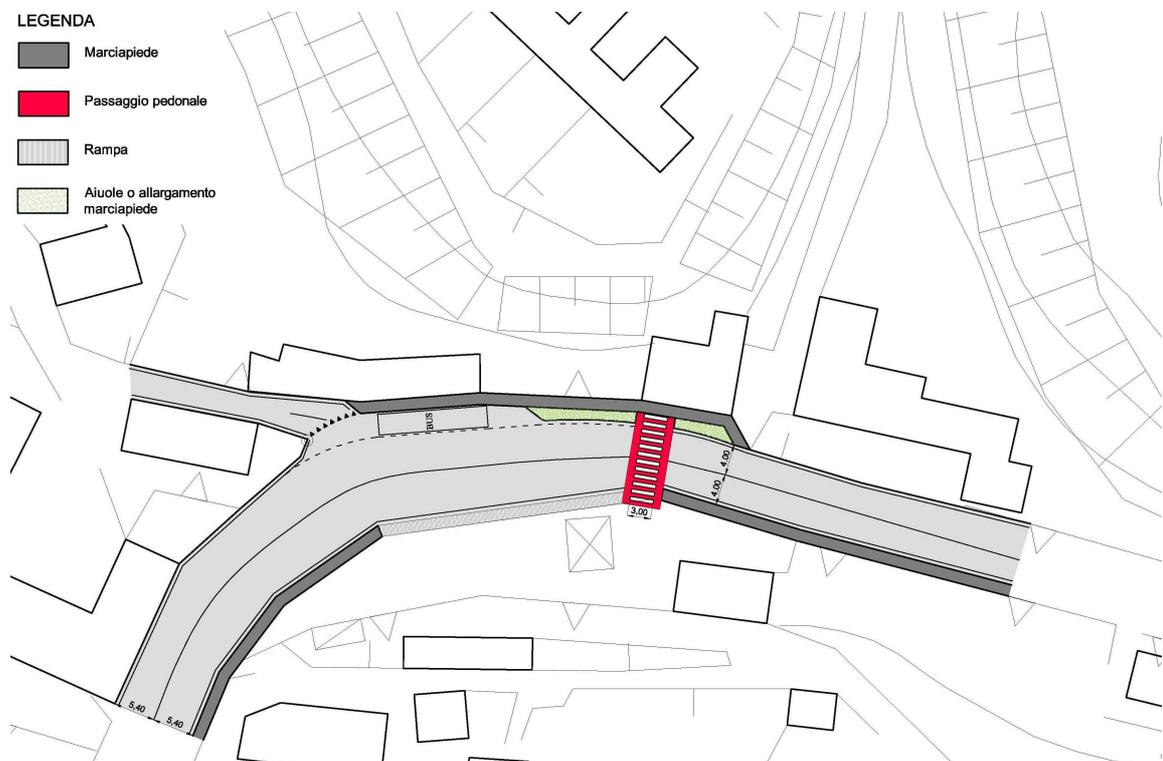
Ipotesi di sistemazione dell'accesso al Ponte Nuovo dalla sponda sinistra.
